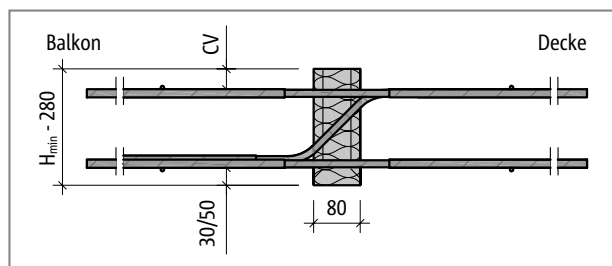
Schöck Isokorb® tipo KP150L: Sezione dell'elemento
